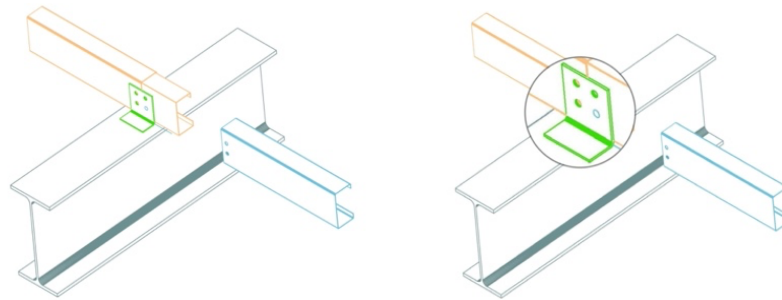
Detalle ejón de anclaje correas en cubierta. CAD Estructuras.
